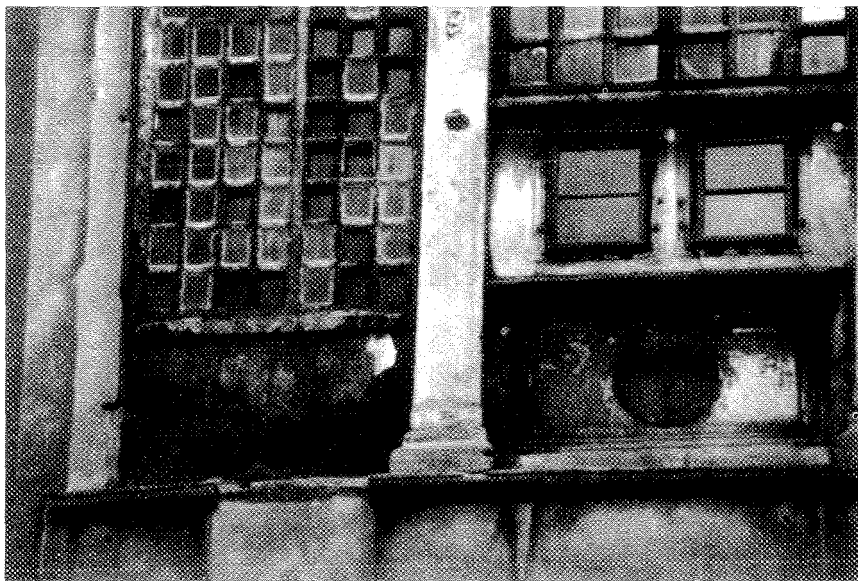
Istanbul, Santa Sofia: lastre 9 e 10 delle finestre sud, lato esterno.
